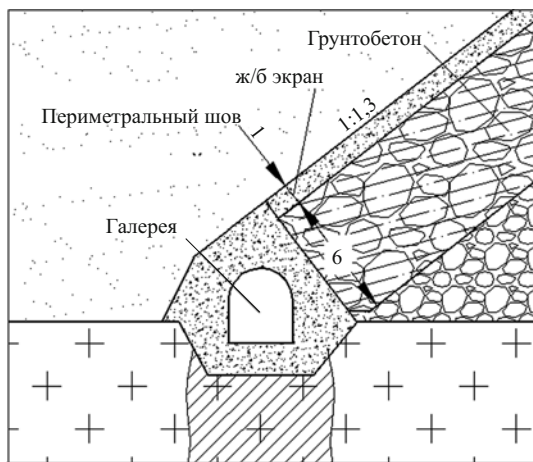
Конструкция узла сопряжения экрана и подэкрановой зоны с железобетонной галереей
